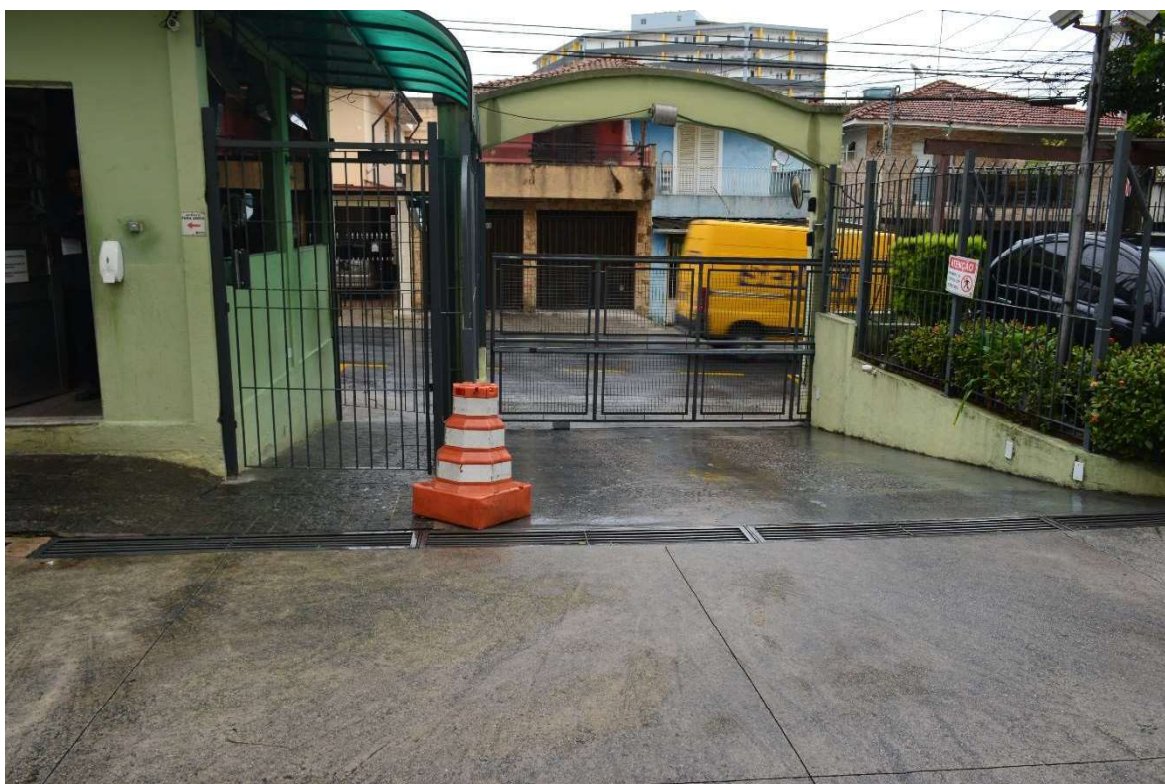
VISTA OPOSTA DA ENTRADA DA RUA MAURÍCIO JACQUEI.
